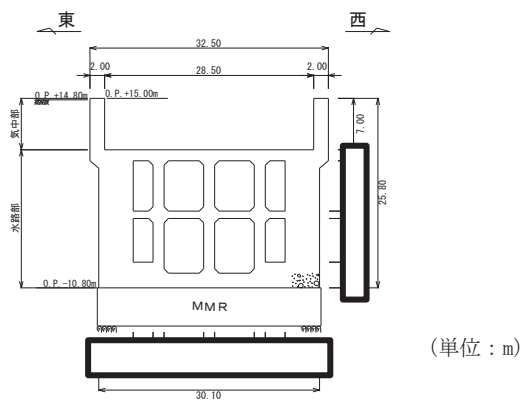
海水ポンプ室断面図 (A-A 断面, 東西)
